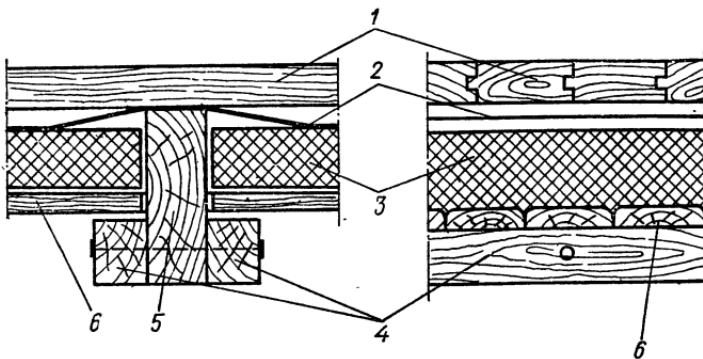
Фрагмент цокольного перекрытия с опиранием «черного» пола по черепным брускам
